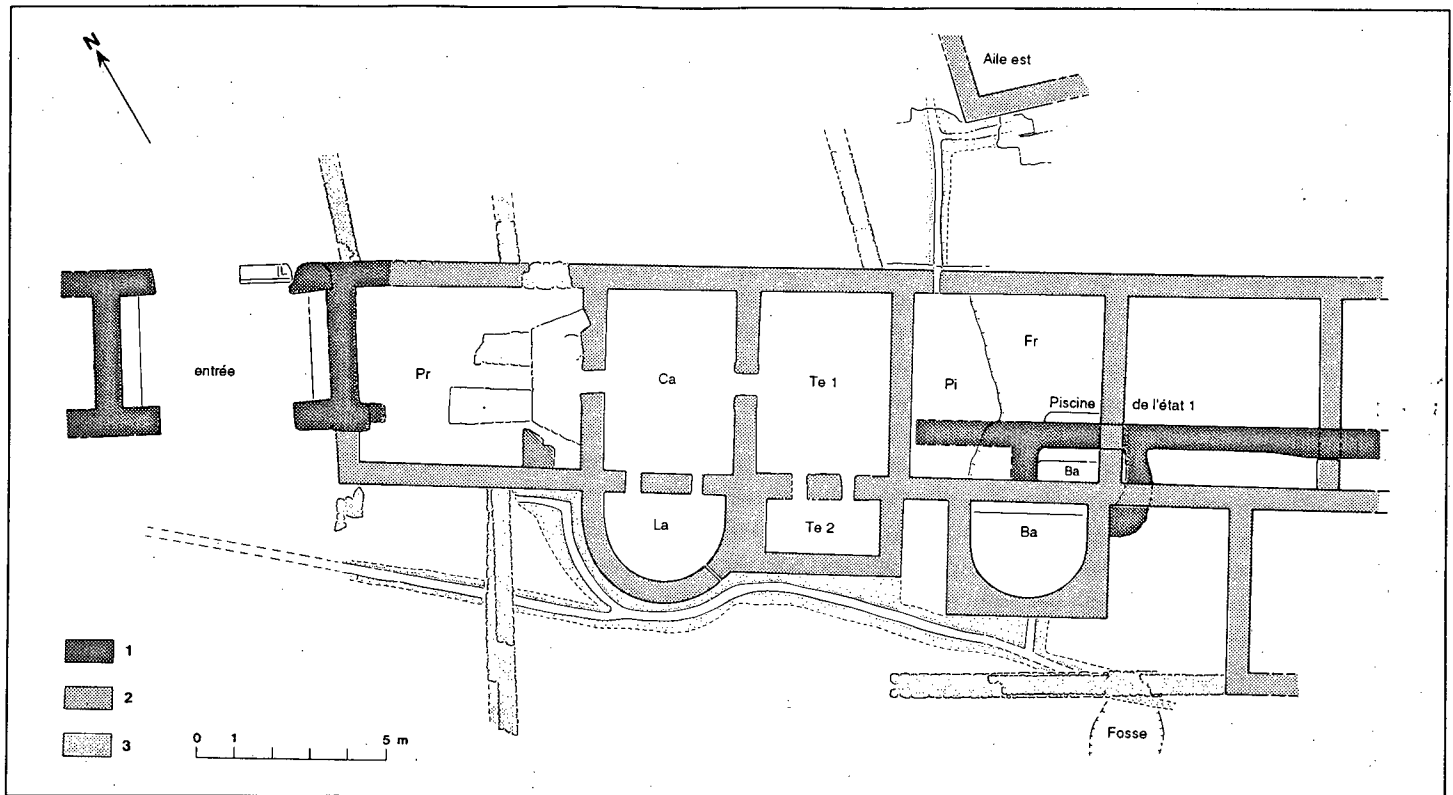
EYGUIÈRES, Saint-Pierre de Vence. Plan des constructions de l'aile sud, avec indication des trois états successifs.
